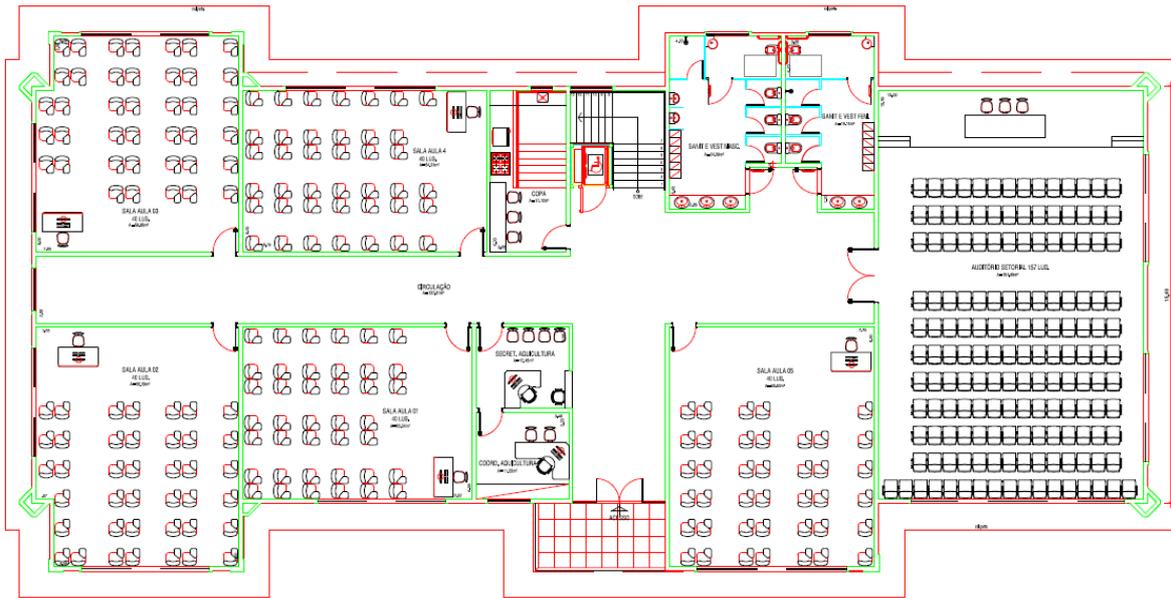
Planta estrutural do térreo do Prédio de Organismos Aquáticos.
